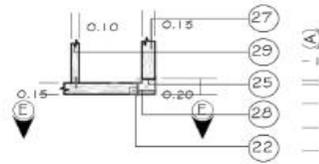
Planta de detalle 9 (Cubierta)-Esc:1/50
